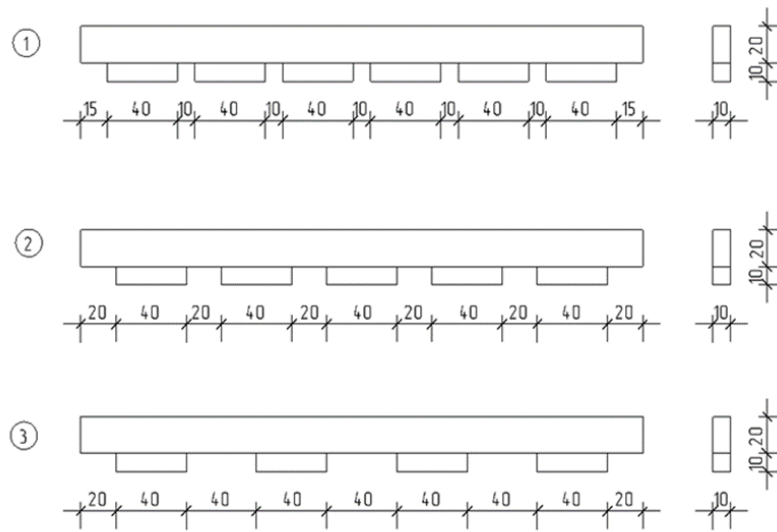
Моделі переривчастих фундаментів: 1 – крок між фундаментними плитами 10 мм; 2 – крок між фундаментними плитами 20 мм; 3 – крок між фундаментними плитами 40 мм
